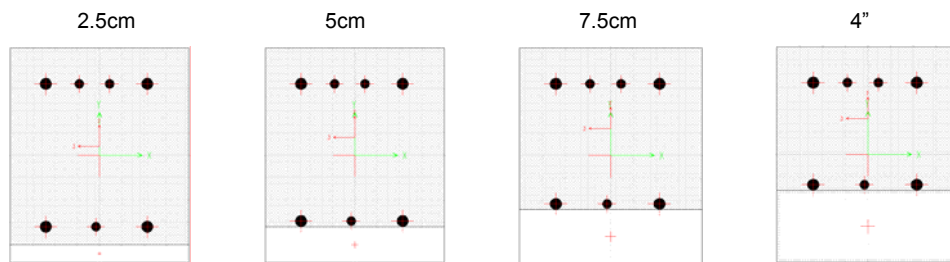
Ejemplo de secciones consideradas, producto de una tubería embebida horizontalmente en una viga abajo refuerzo.
